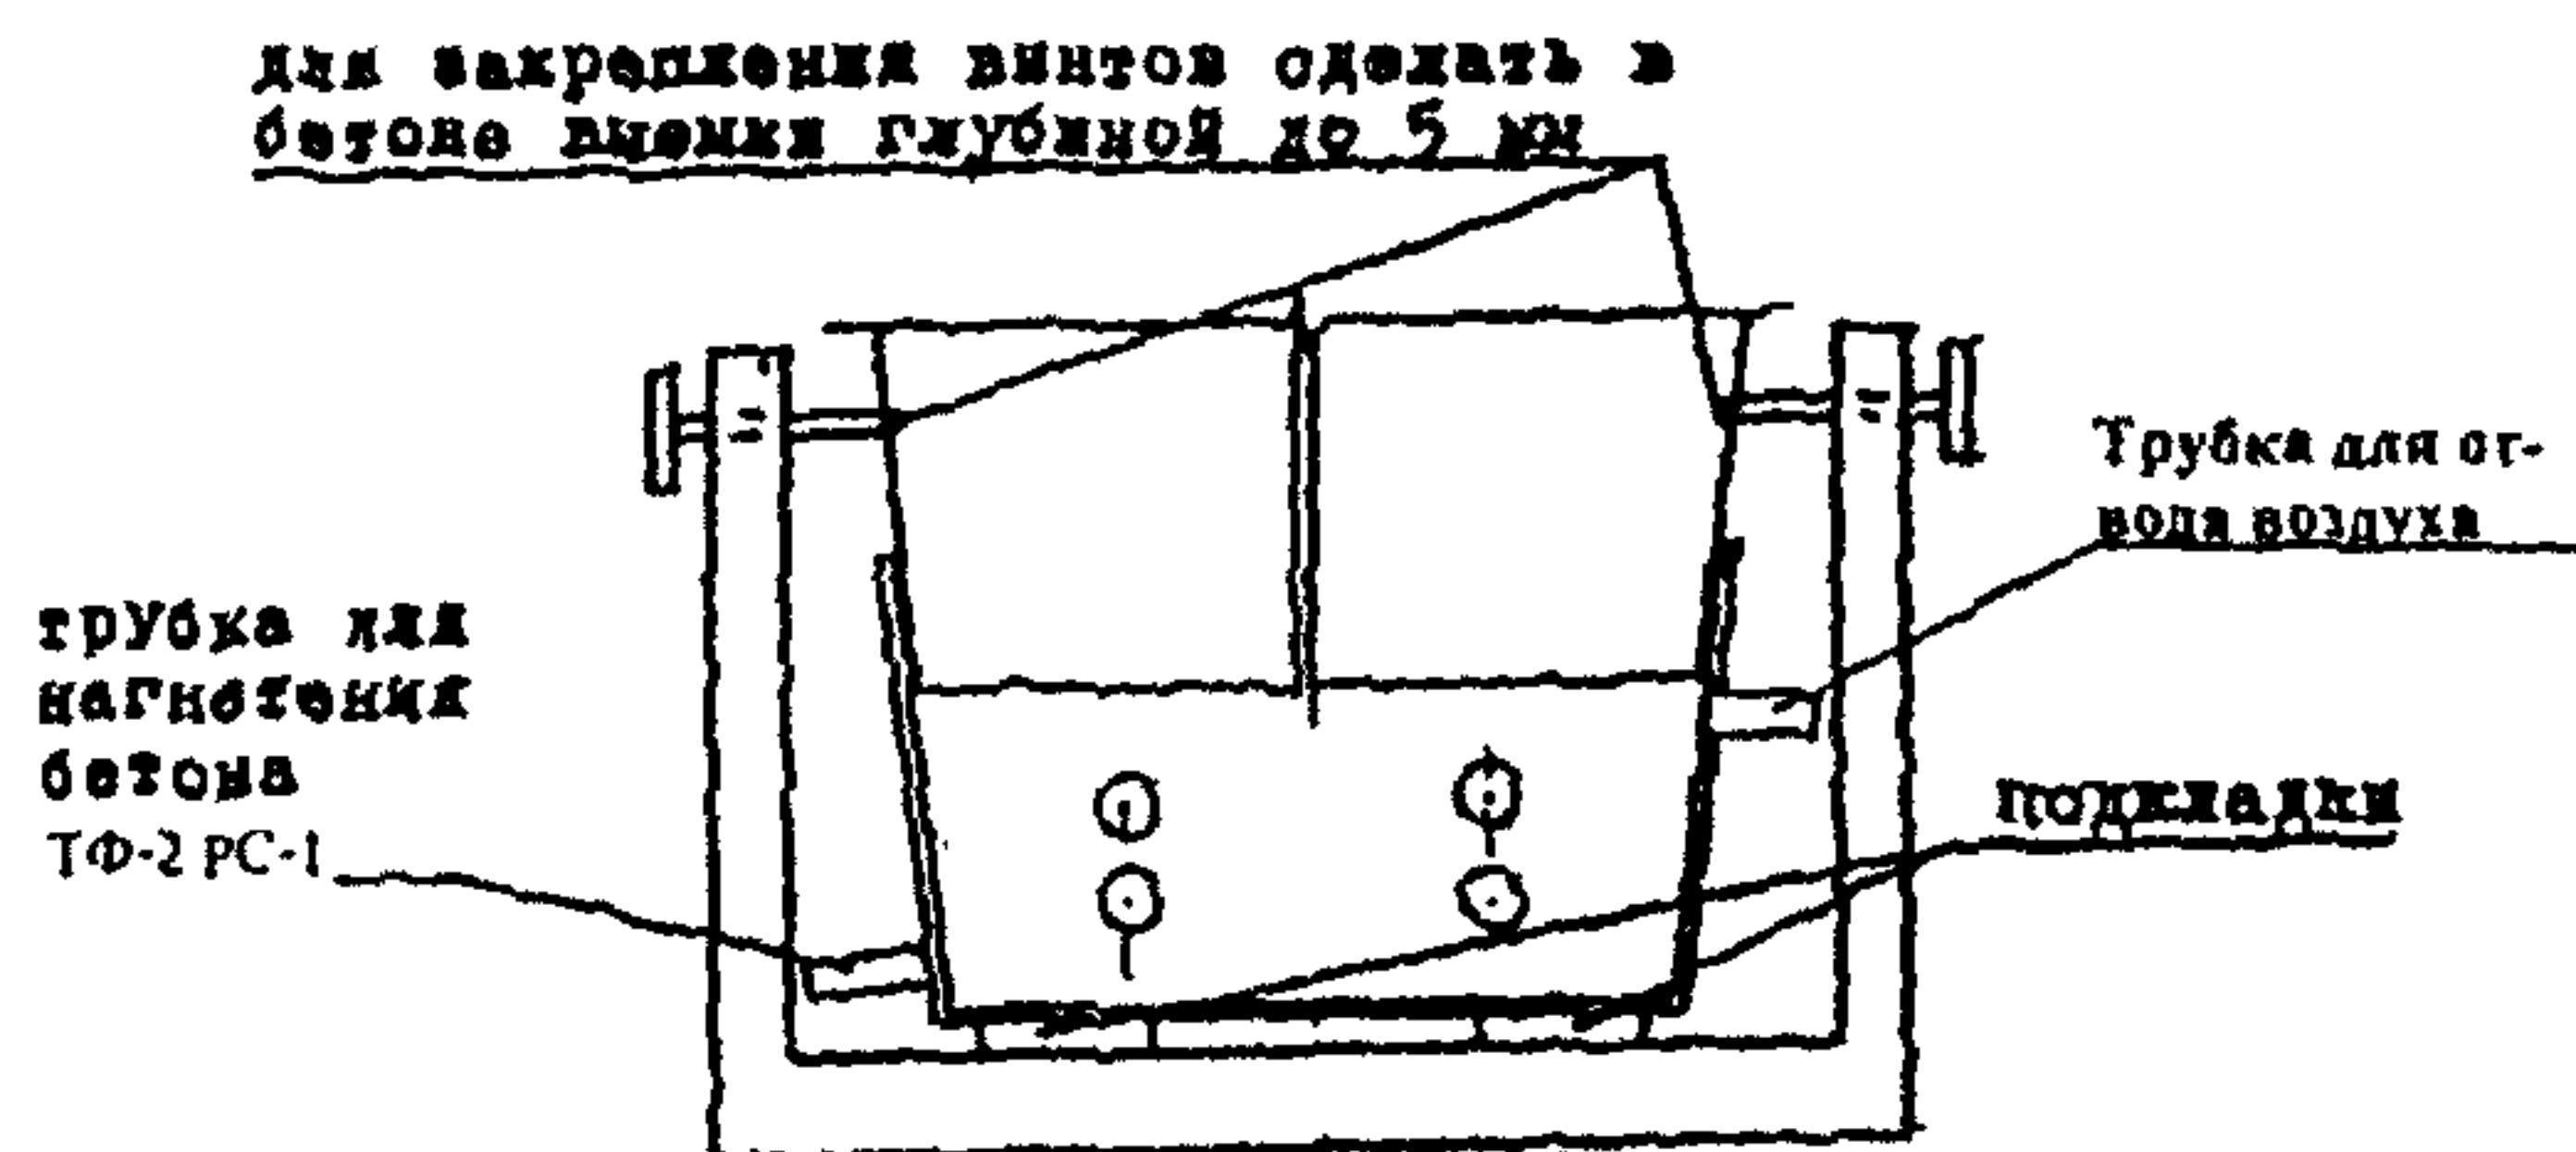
Схема устройства опалубки. Для прижима ее краев к бетону могут применяться дополнительно струбцины
